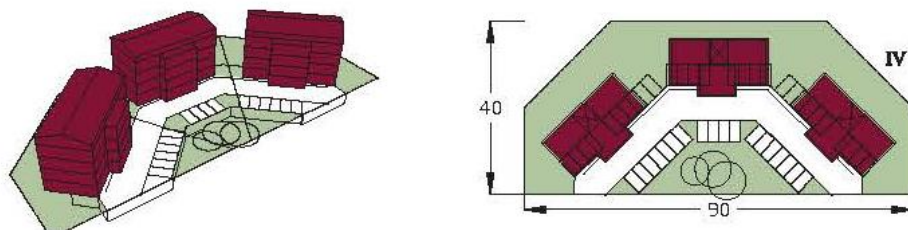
Byggnaderna kan placeras vid ett gemensamt tun och anpassas till terrängen (bild Monarkens Arkitektkontor).
